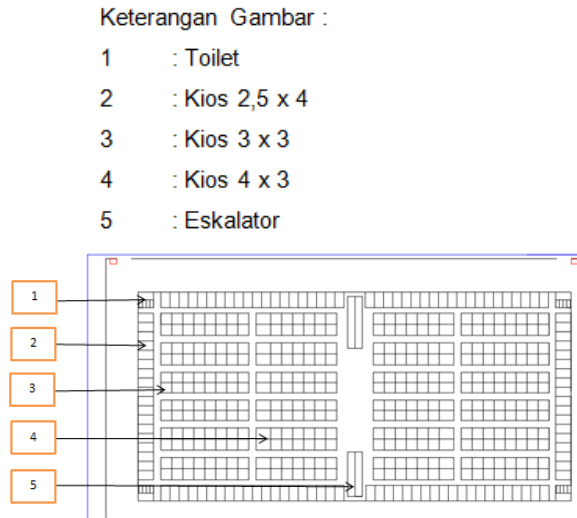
Denah Pasar Ciputat Ciawigebang Lantai 1
